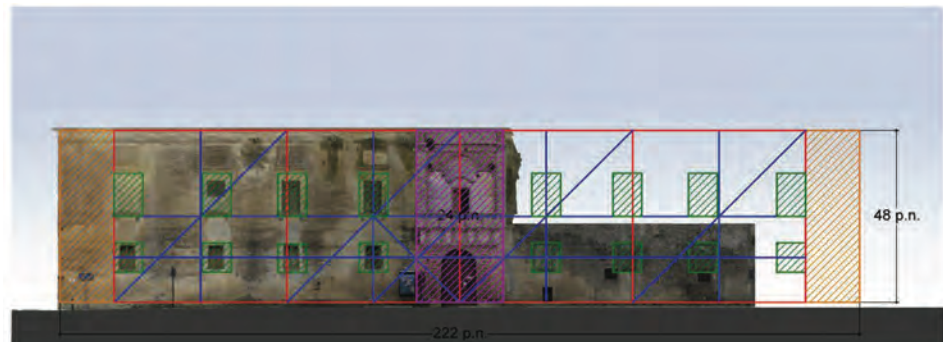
Schemi geometrici del prospetto principale (Schema D, E, F).
